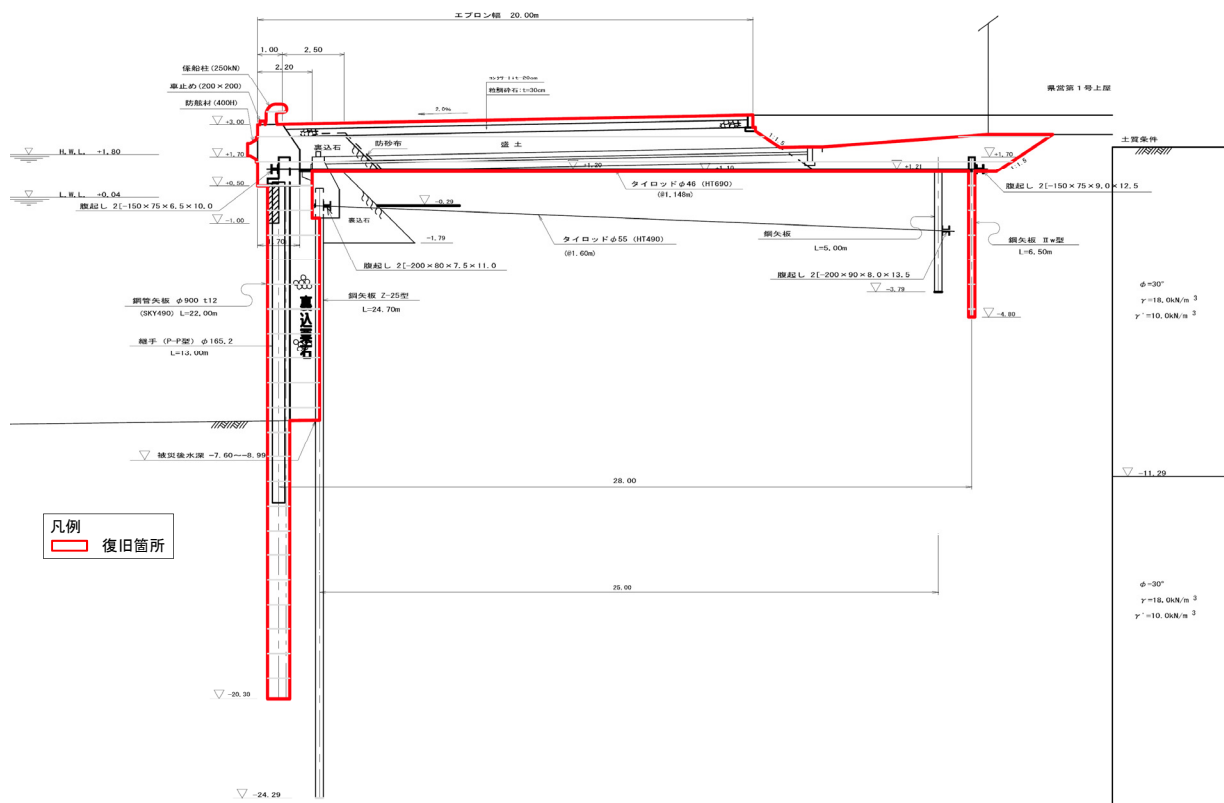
地盤モデル図 (A, B, C, F 断面)
